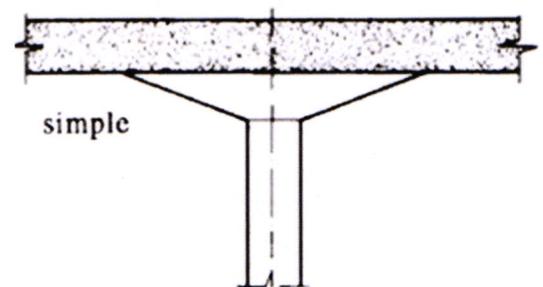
dalle champignon/ source : <https://www.forumconstruire.com/construire/topic-289874-difference-de-prix-entre-dalle-avec-vide-sanitaire-et-sur-plot.php>
